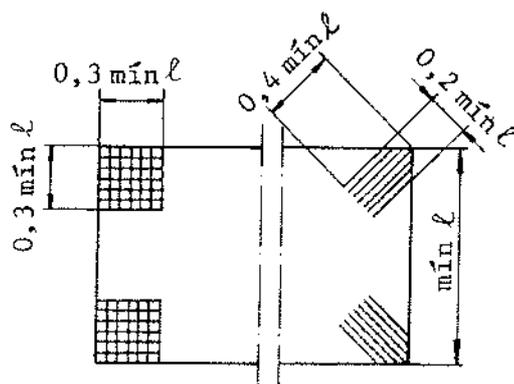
Armadura superior de esquina: ortogonal y oblicua.
